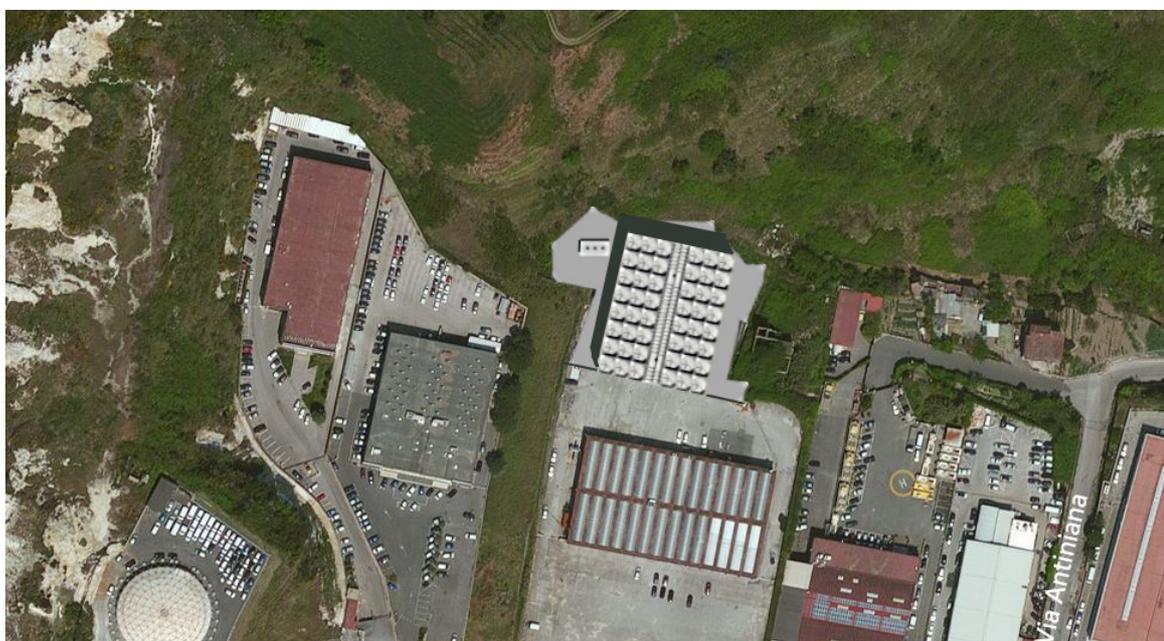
Vista tridimensionale dell'impianto geotermoelettrico di progetto
